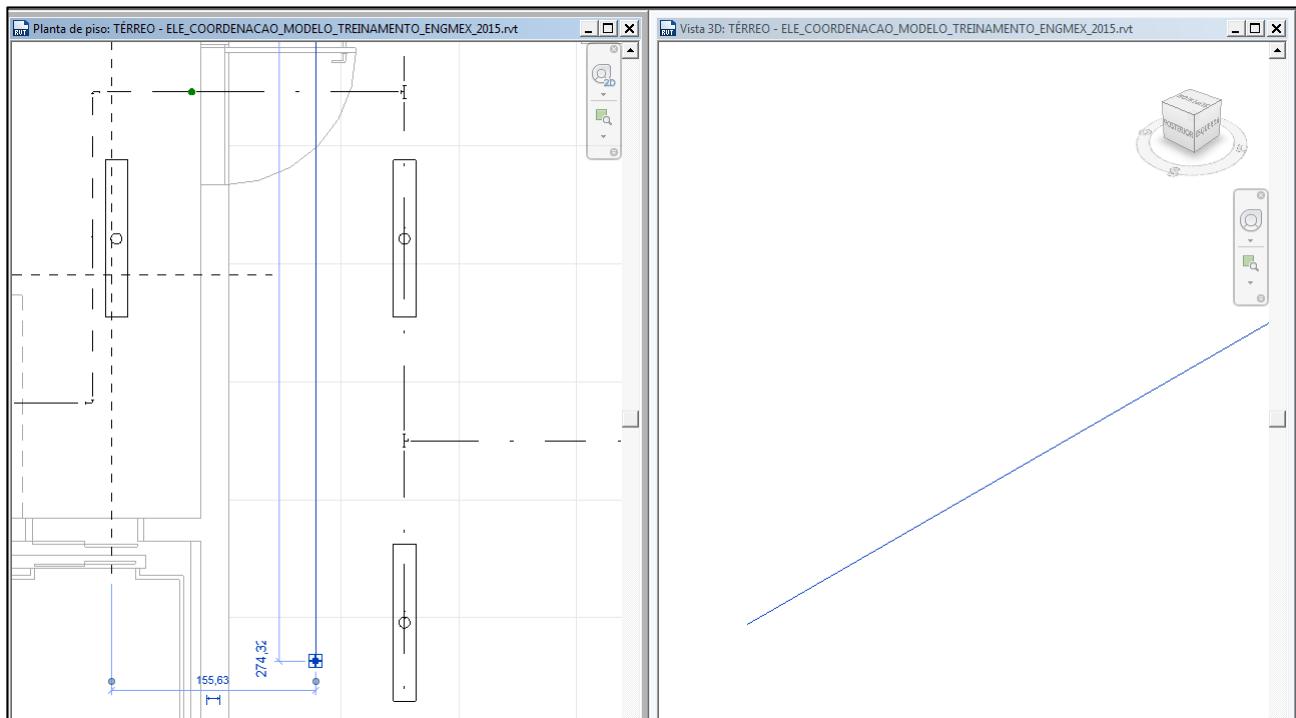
ELETROCALHA VISTA EM NÍVEL DE DETALHE BAIXO.
